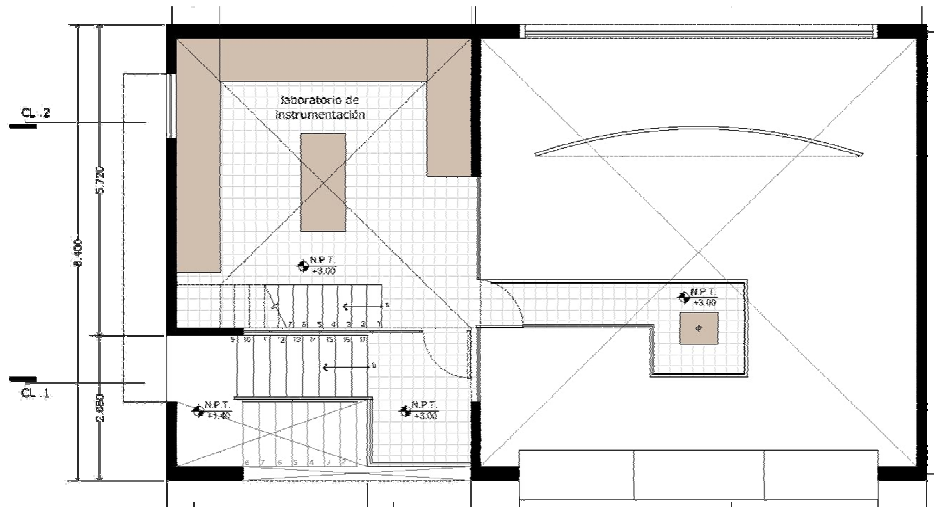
Plano planta del laboratorio de instrumentación. Nivel +3.00 m (Cortesía Xavier Hierro y Oriana Romero)
